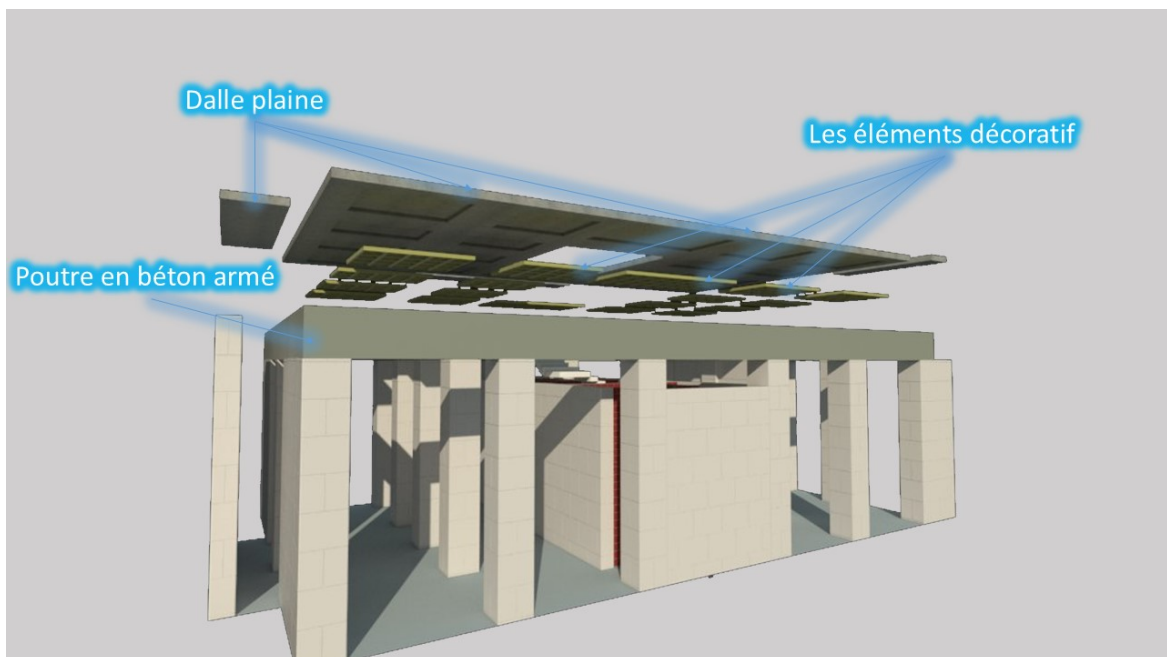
Les éléments qui composent la dalle, les cloisons et les murs en pierre (RDC)
